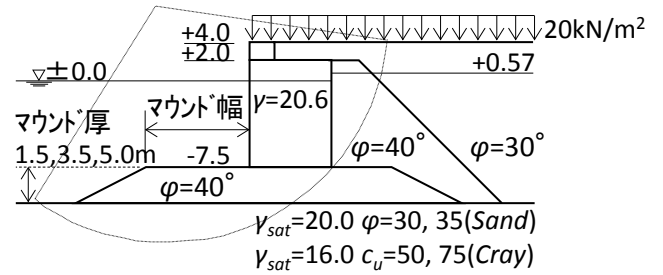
ケーソン式岸壁の断面モデル(積上型マウンド)
